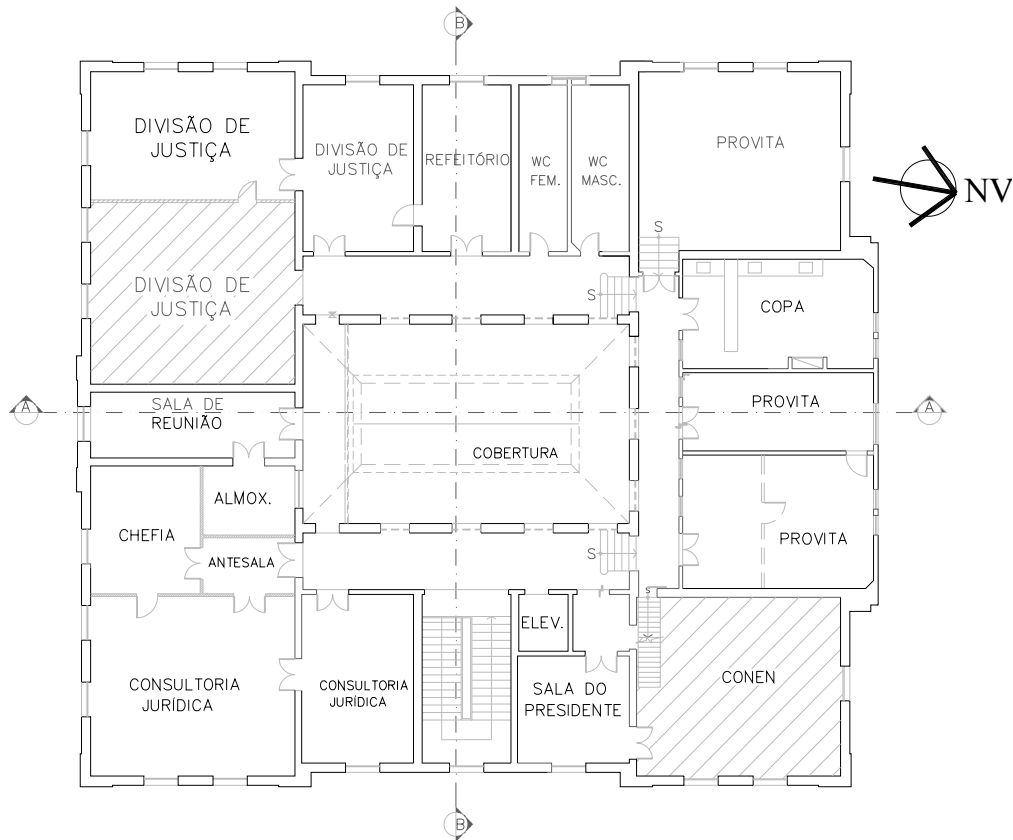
planta baixa do 3º pavimento - edifício 148;
